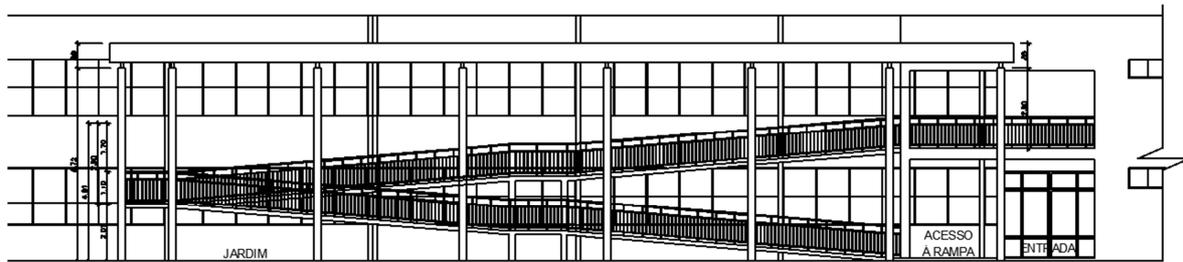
PAVIMENTO SUPERIOR - BLOCO PEDAGÓGICO – CAMPUS PLANALTINA
